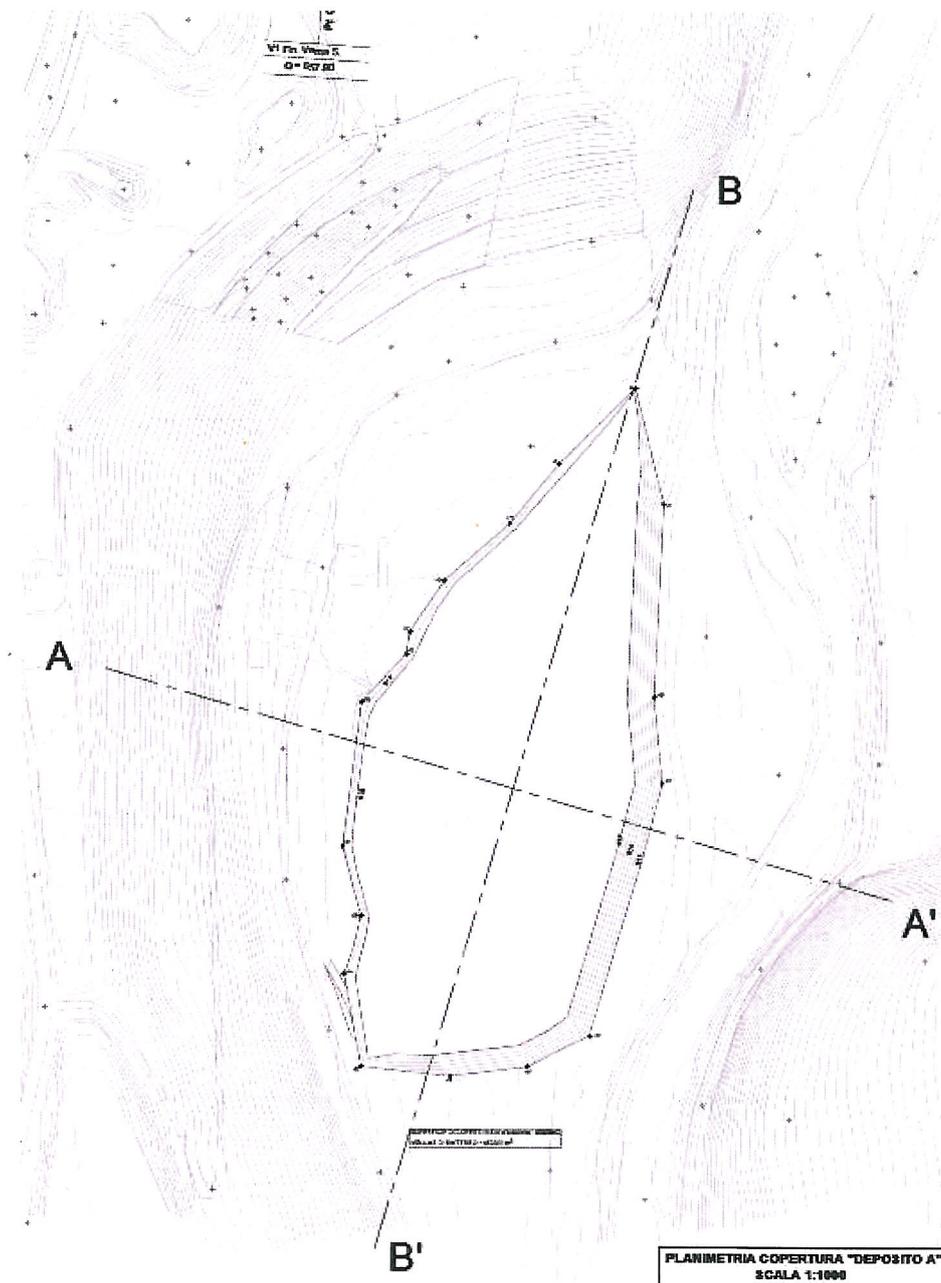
Depositi definitivi in Val Riga – A – Vorderrigger – Planimetria di progetto
